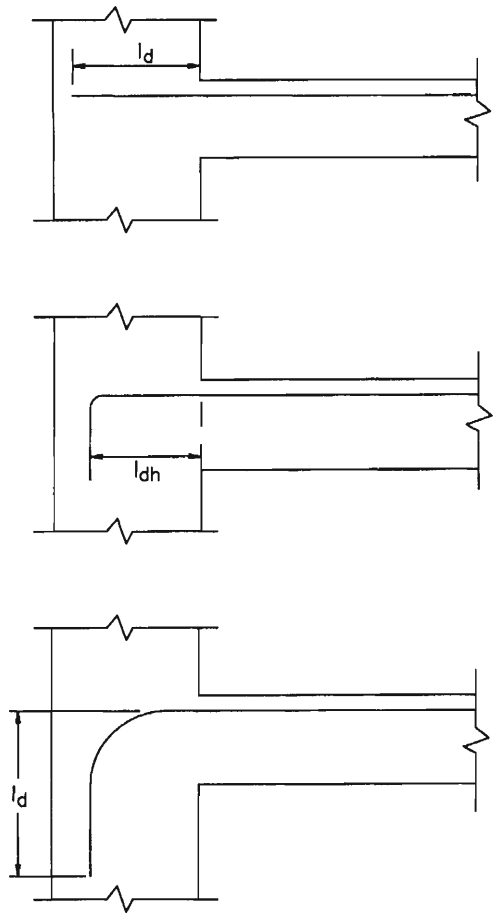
Anclaje del refuerzo longitudinal en los apoyos
